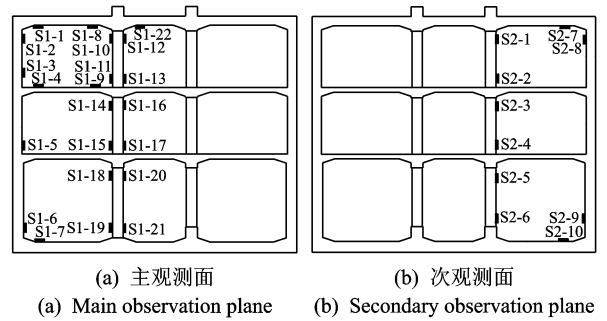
地铁车站模型结构横断面上各观测面应变片布置图
